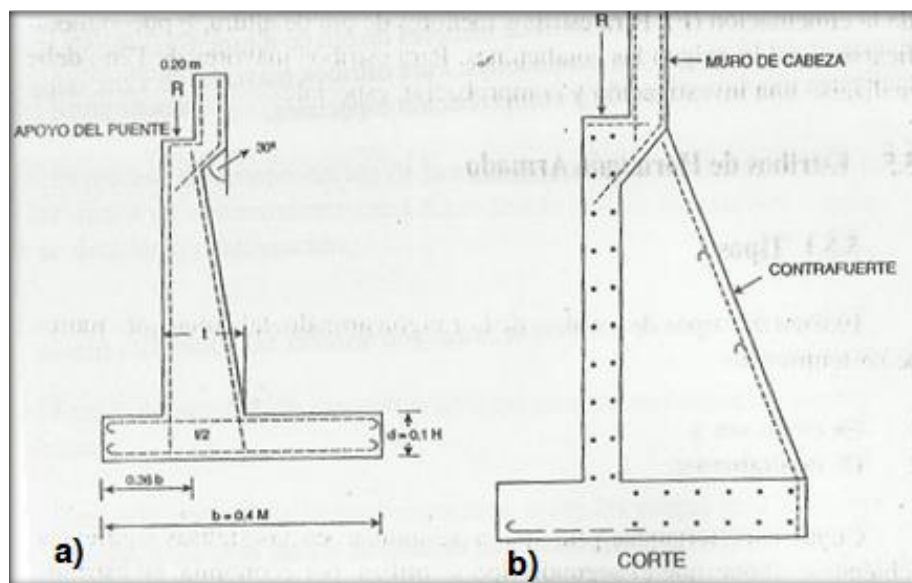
Geometría de estribos de hormigón armado. a) en cantiliver – b) de contrafuertes
